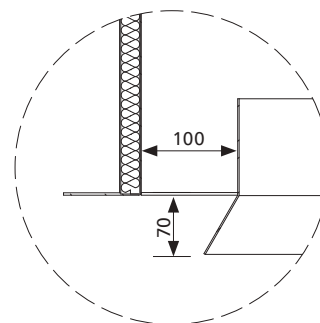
Kierownica wlotowa zamontowana w klapie mcr PROLIGHT typ DVP
